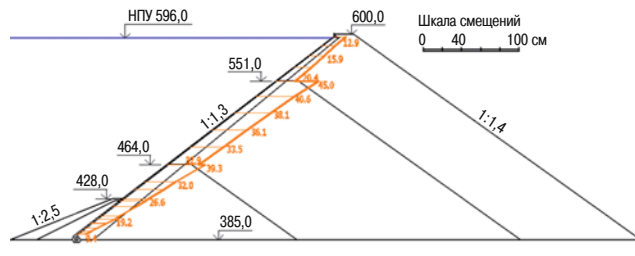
Смещения железобетонного экрана, см, для варианта 3
